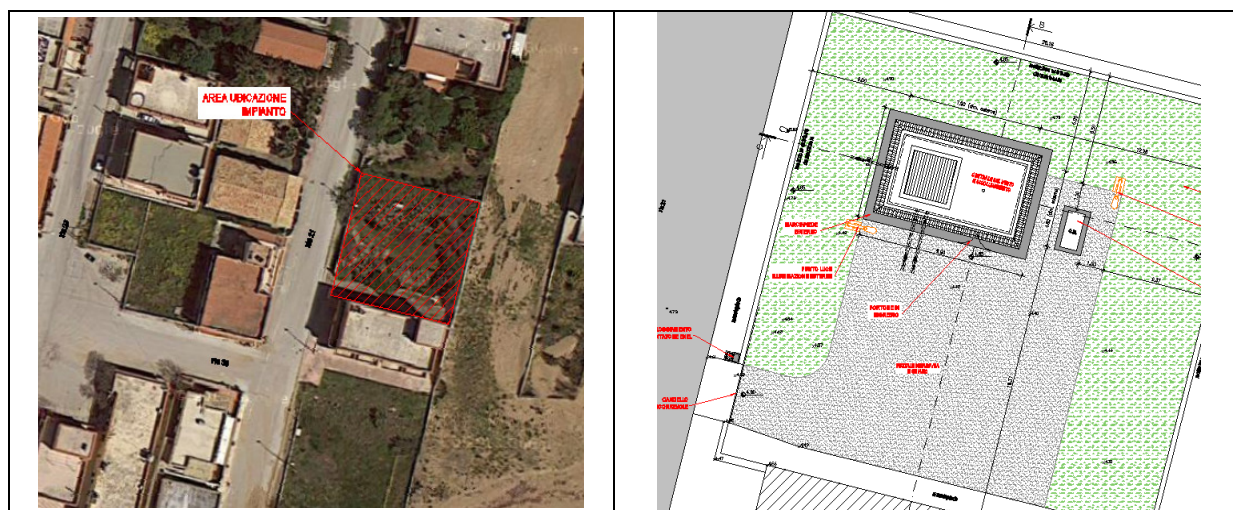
Localizzazione territoriale dell'impianto e planimetria con le sistemazioni previste.
